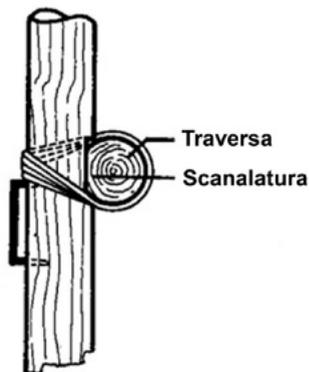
Fissaggio sicuro della traversa al palo del cavalletto (USTRA)
